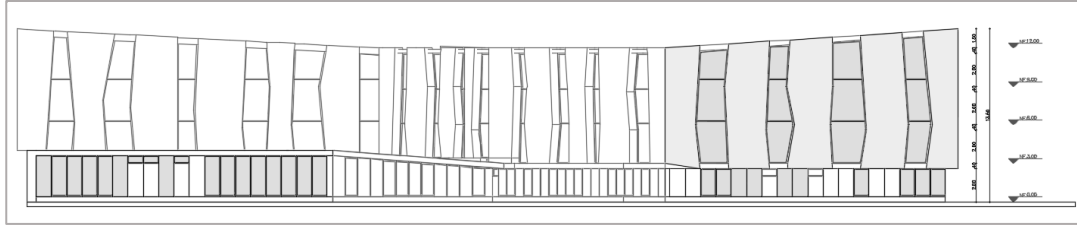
Fachada parque el lago carrera 36ª. Elaboración propia
